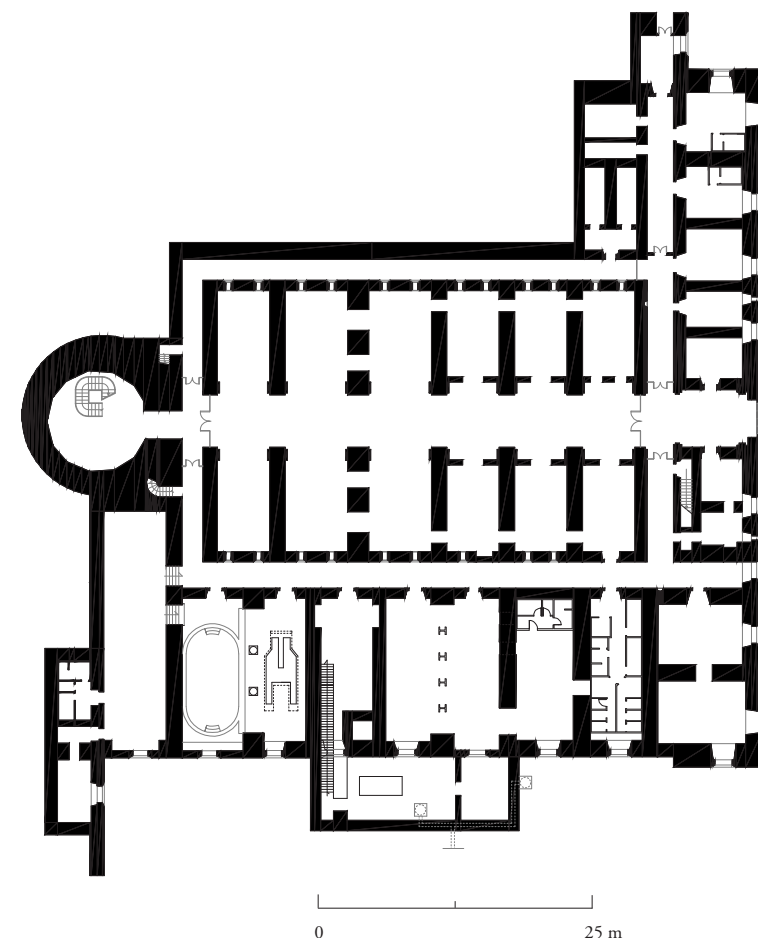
ricostruzione della pianta originale della torre corazzata.
